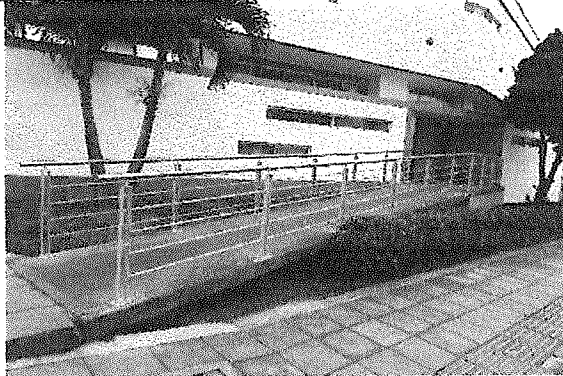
ESTACION NORTE (Intervención fachada principal)
